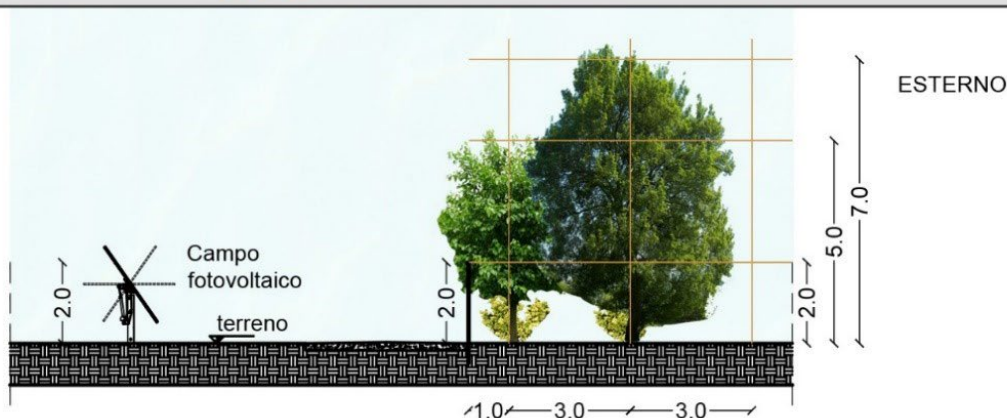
Schema d'impianto prospetto, planimetria e sezione dell'area campione A - fascia di mitigazione Sez. A'-A"
